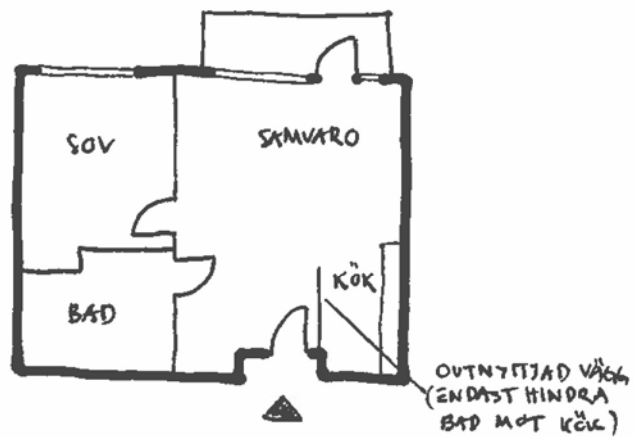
6.3.1, 1 ROK och 2 ROK, Kallebäcks äldreboende
